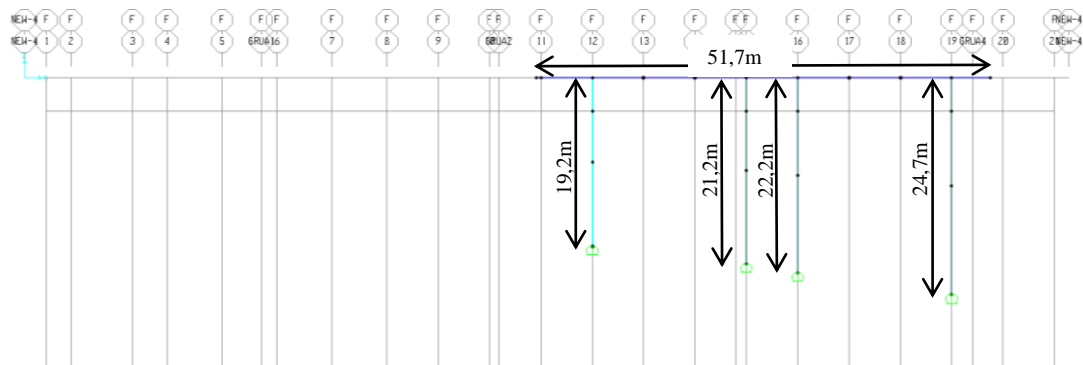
Vista en elevación del plano F de geometría, paralelo a plano X-Vertical'.
